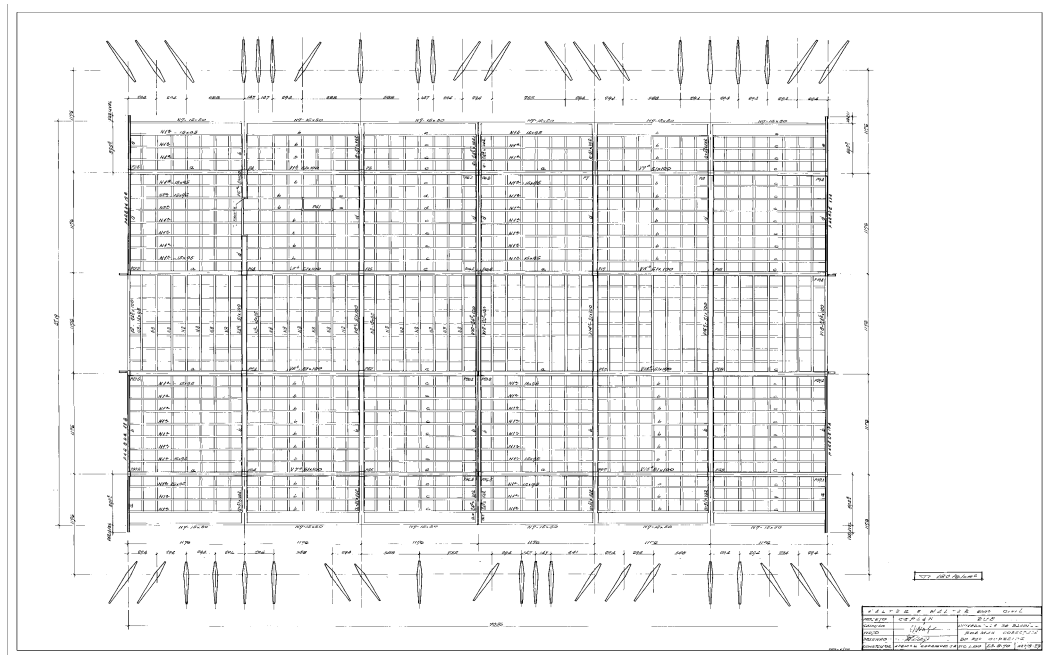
Planta de forma da laje de cobertura (CEPLAN).
